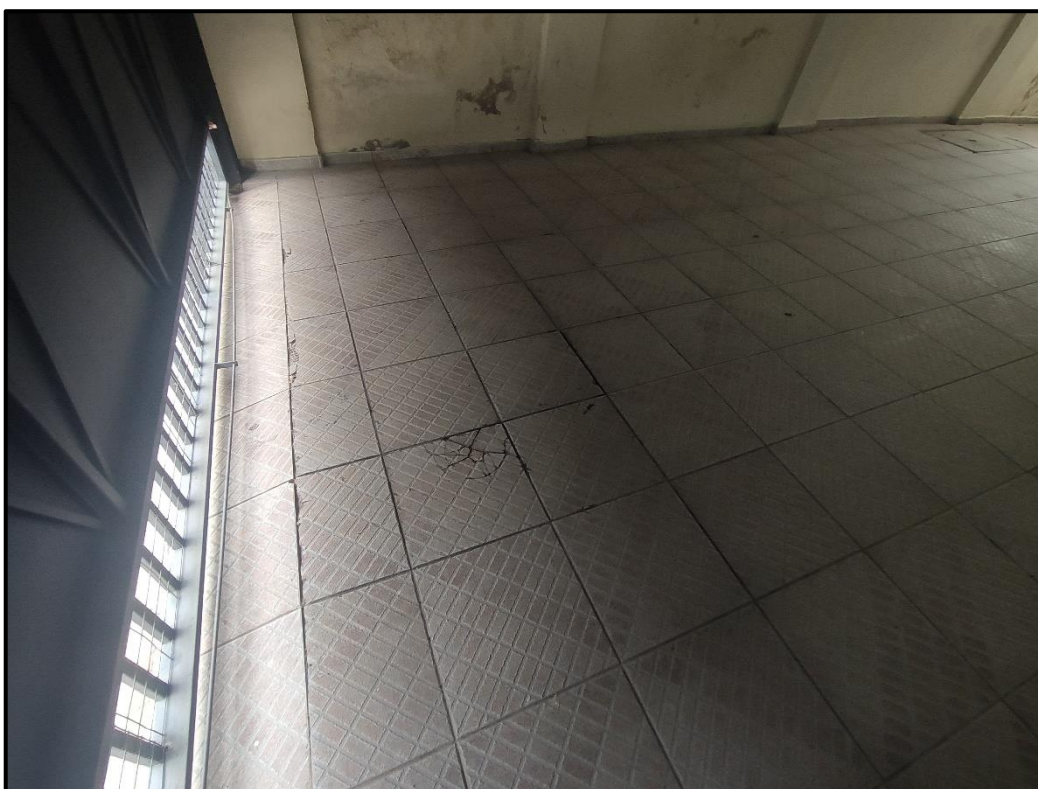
Pavimento térreo – Estado de conservação da garagem de veículos
